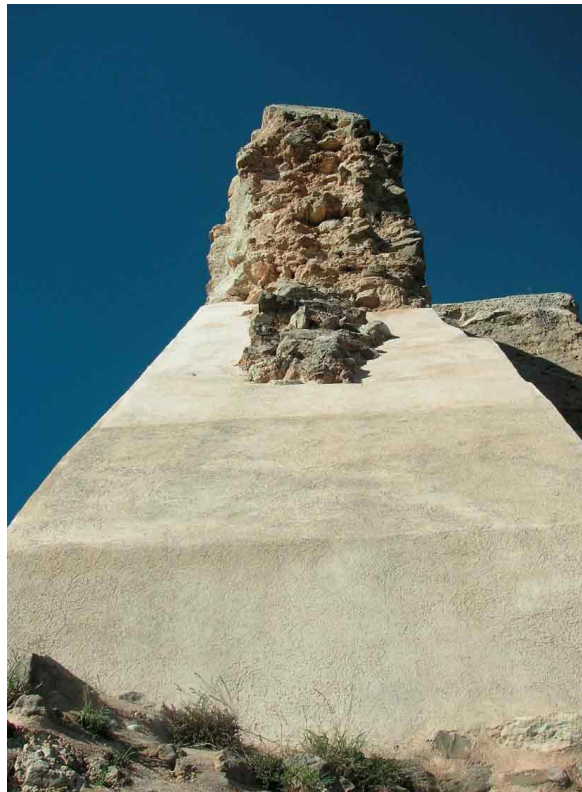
Imagen de la consolidación del muro Norte. (Fotografía de archivo de la UPV).
